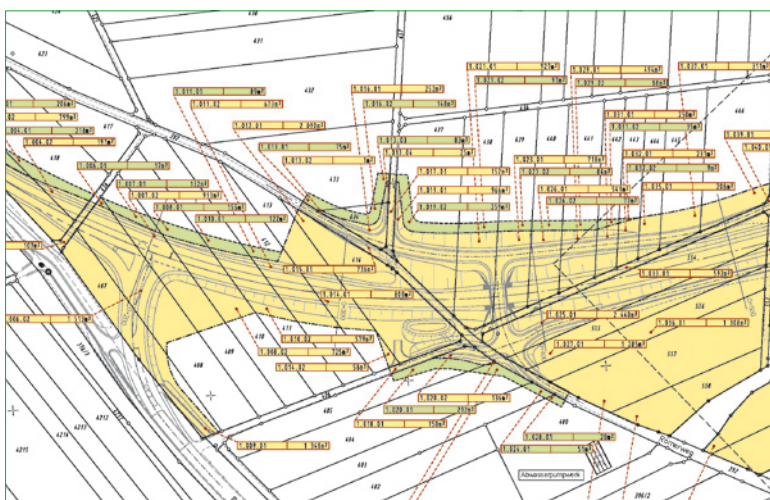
K 1081, Nordumfahrung Herrenberg, Grunderwerbsplan (Ausschnitt)
